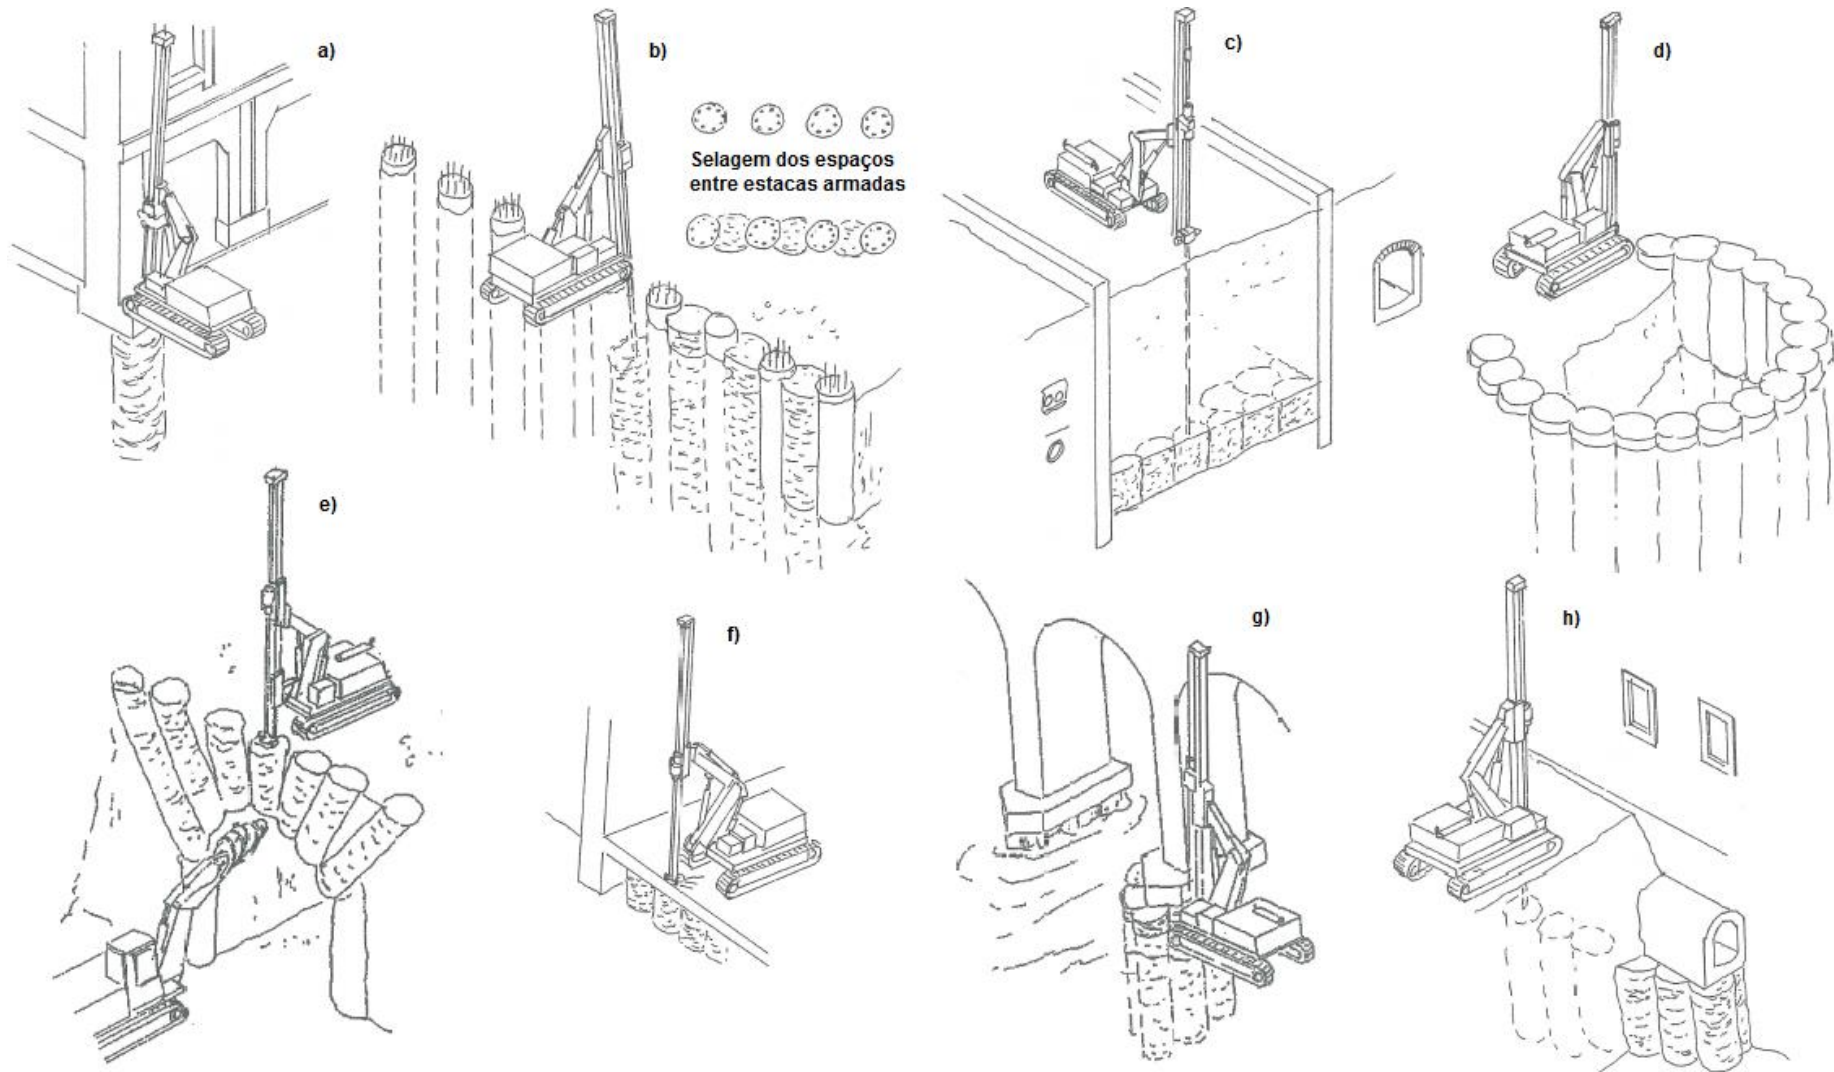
Esquemas de algumas aplicações: a) recalce de fundações; b) cortinas de contenção; c) laje de fundo de contraventamento e impermeabilização; d) poço de contenção; e) consolidação do emboquilhamentos de túneis; f) reforço de ensoleiramentos; g) proteção de pilares de pontes contra a erosão; h) recalçamento de serviços que não podem ser deslocados [54]
